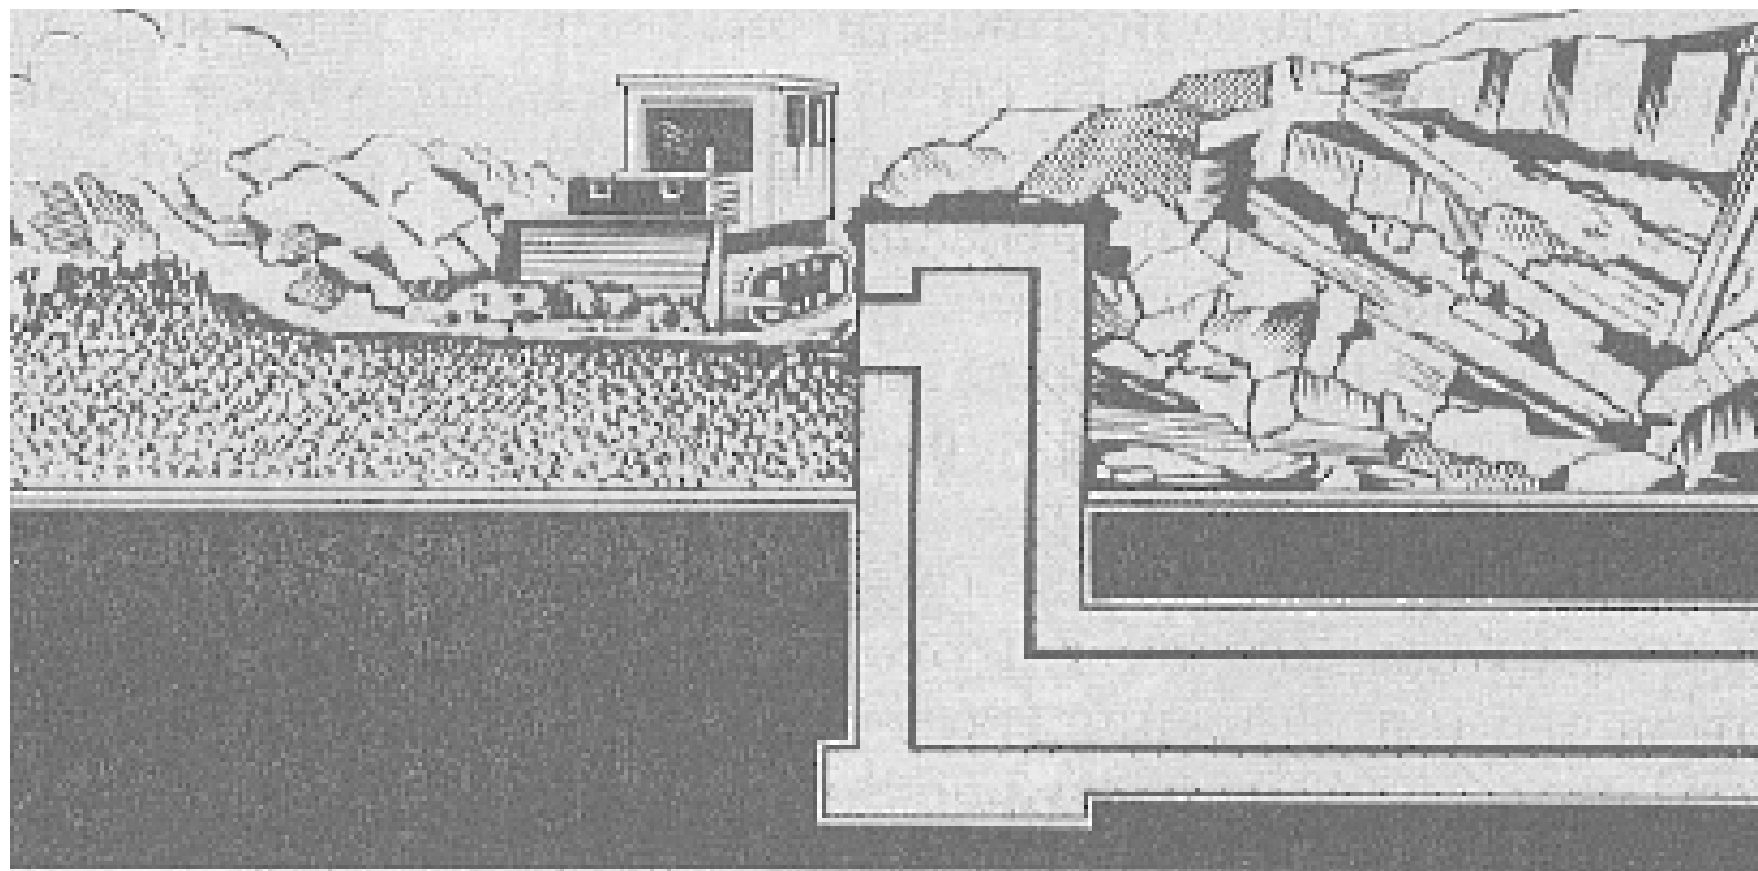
Вскрытие убежища путём пробивки отверстия в перекрытии
